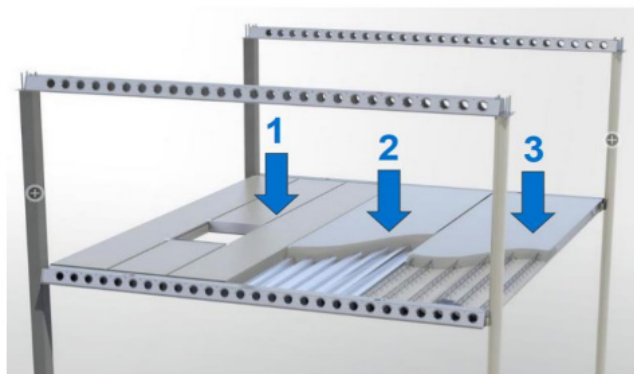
Использование разных типов перекрытий с Deltabeam:
